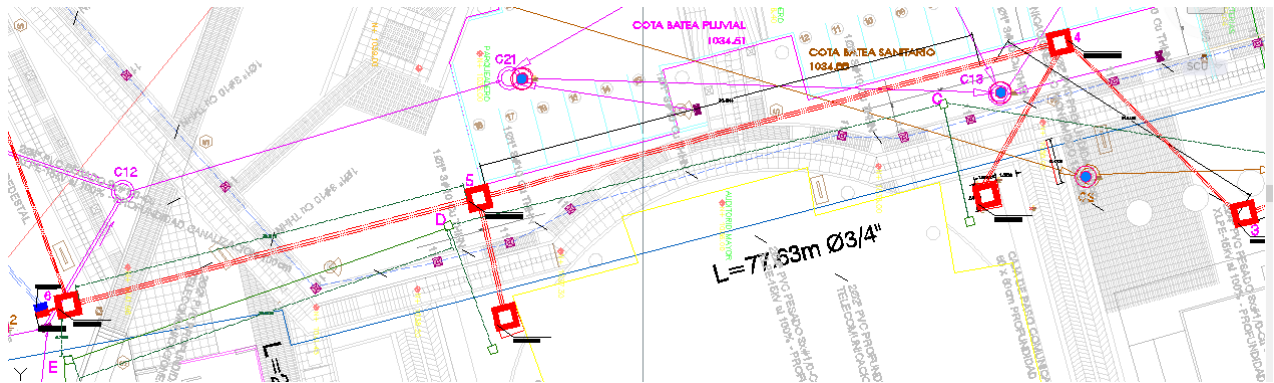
Zoom planta red eléctrica AUTOCAD
